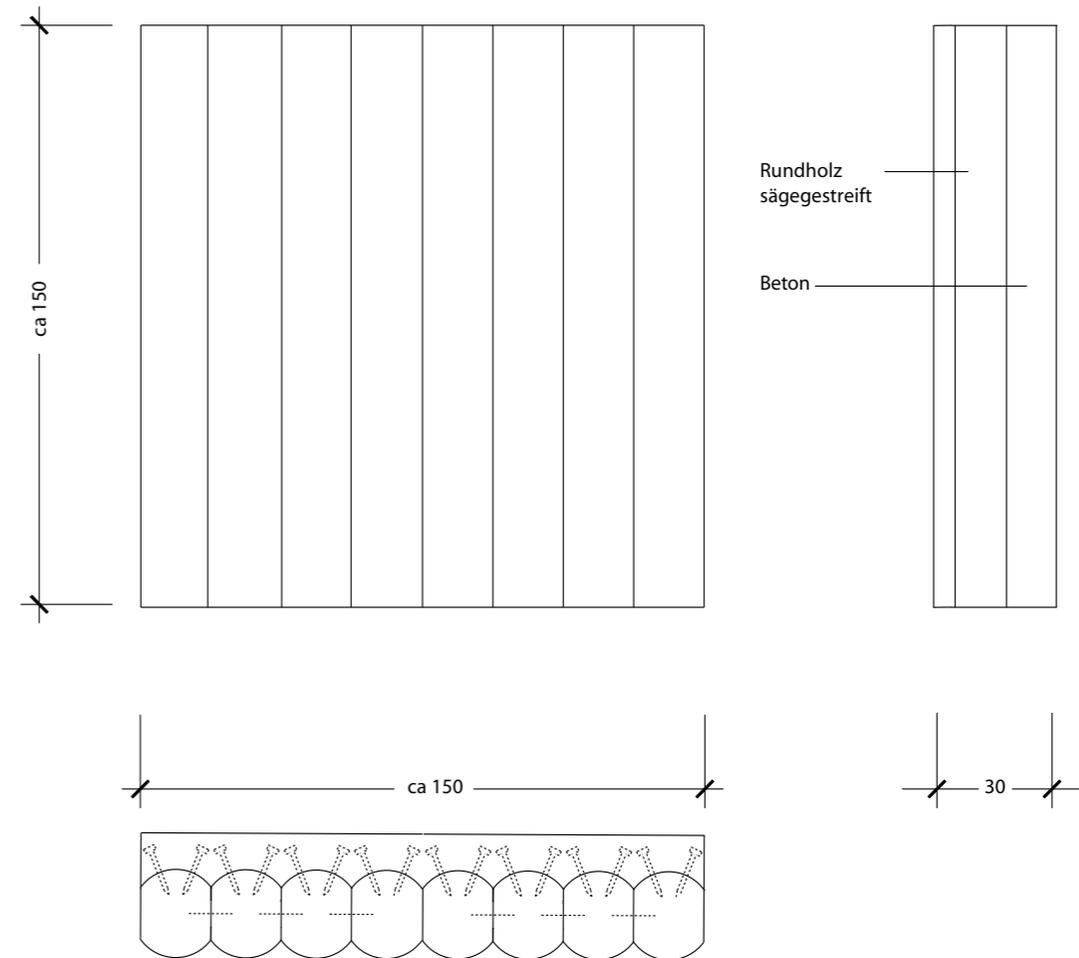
Studie Fassadenelement Detail Holz-Beton Verbund beidseitig besäumtem Rundholz
